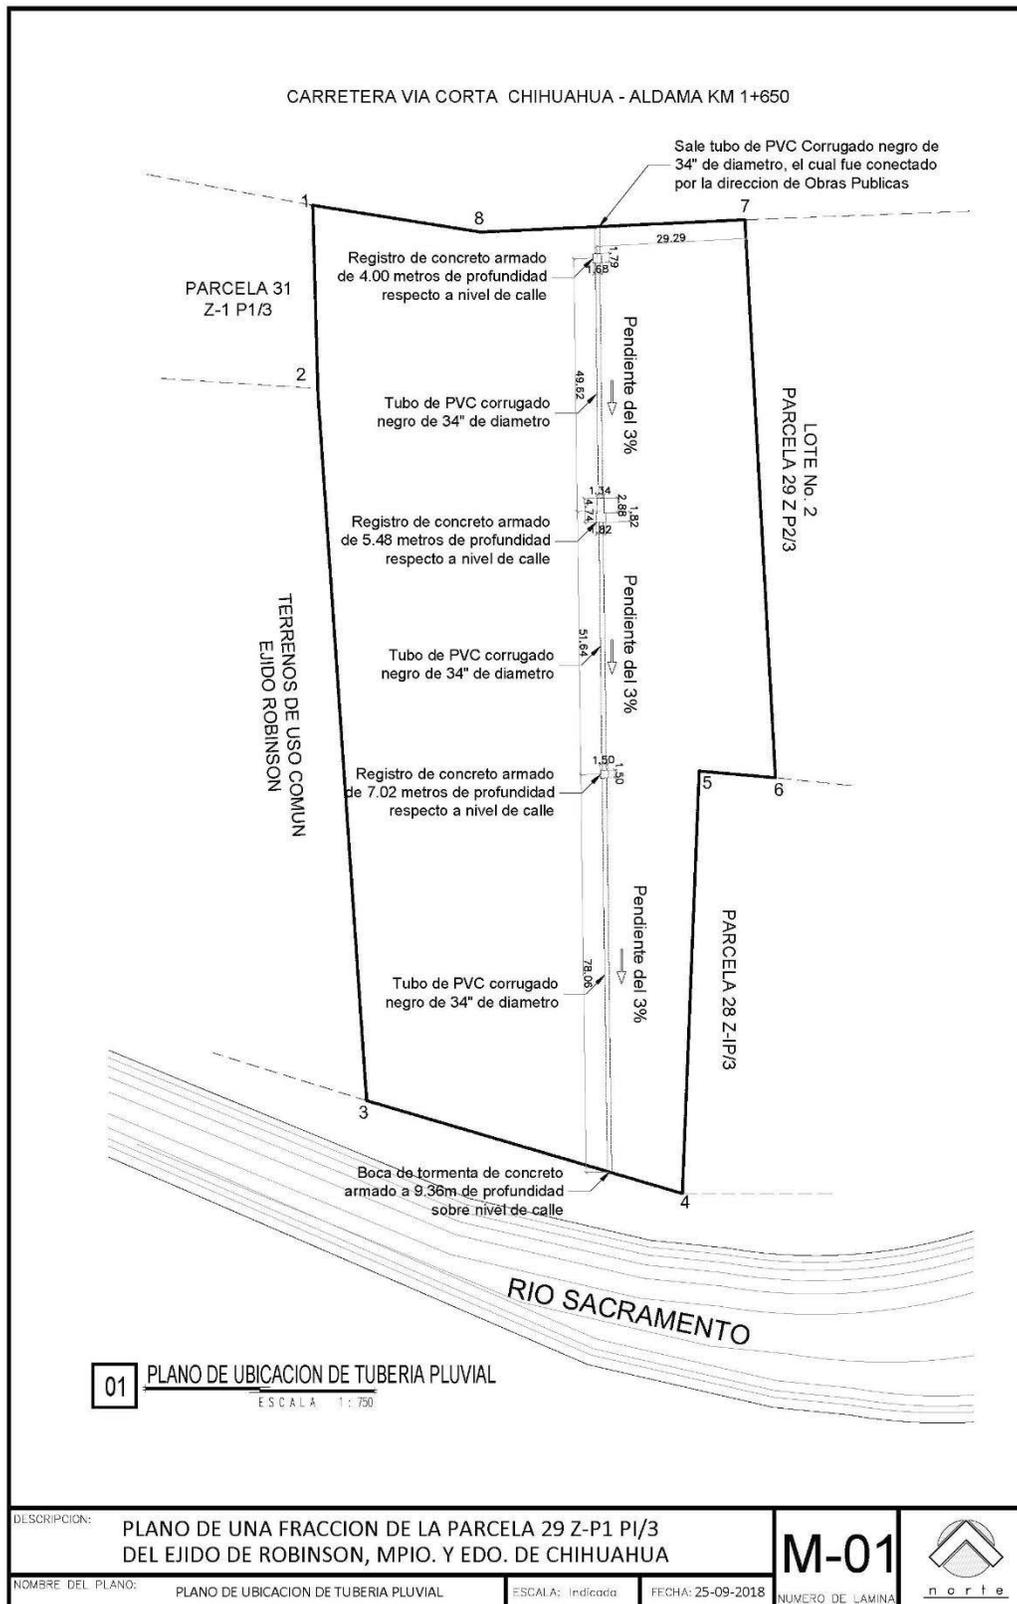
Proyecto de alcantarilla pluvial. Fuente: SECHISA Construcciones.
